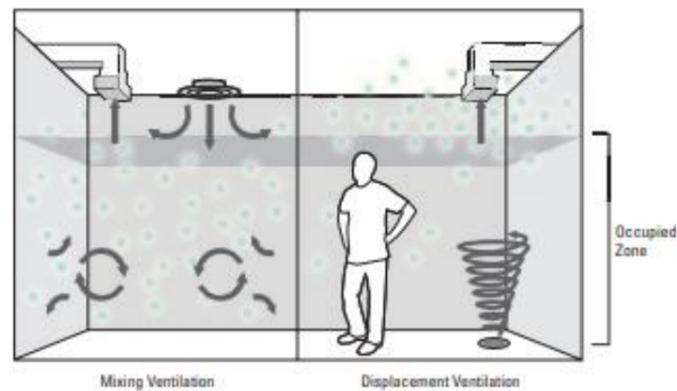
Ruang Dengan Distribusi Udara Bawah Lantai.
